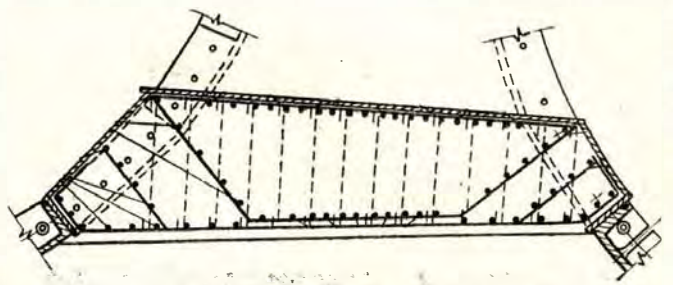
Лотковая железобетонная перемычка с металлической гидроизоляцией.
